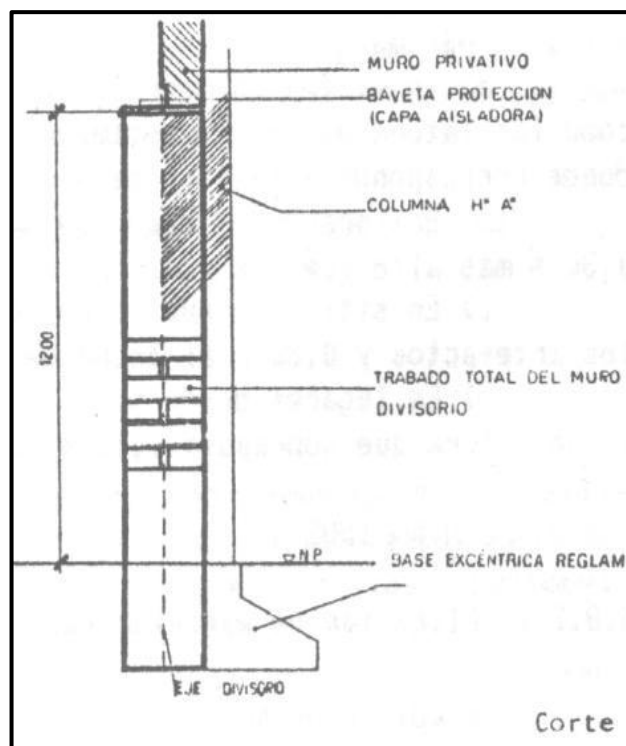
Implantación de la Estructura Independiente sobre la pared de Mampostería
